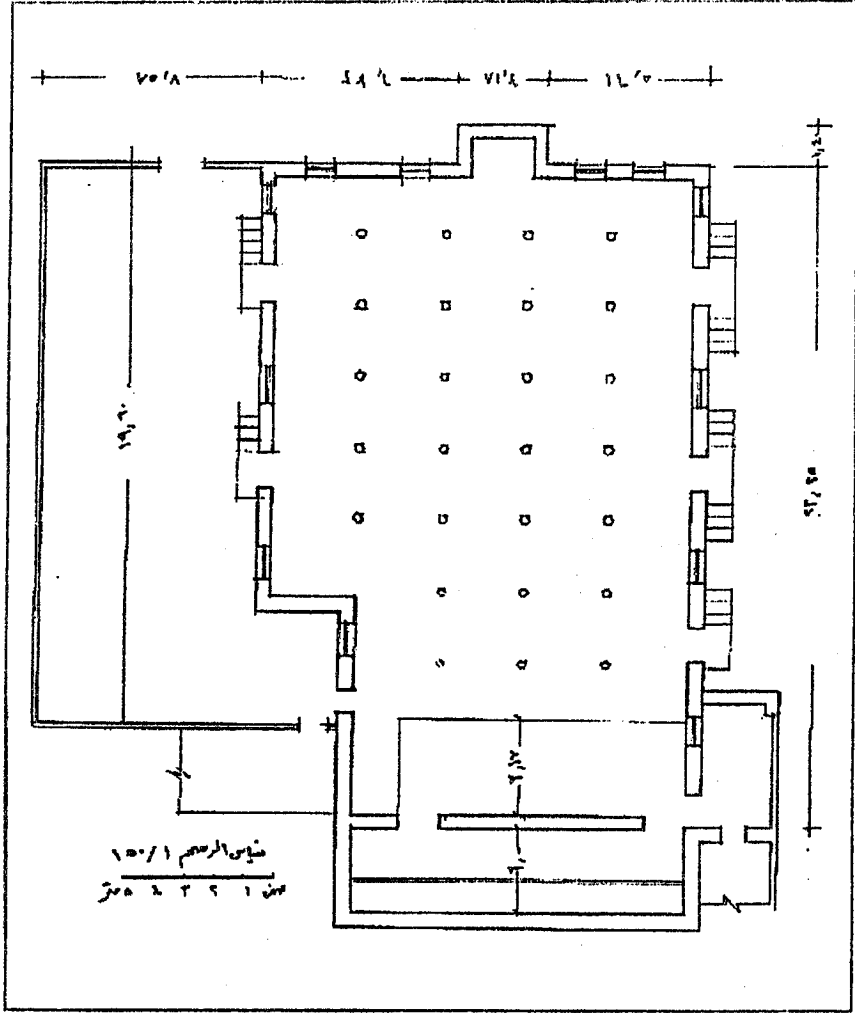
مسقط أفقي لجامع فخر الدين (عن Horton).
